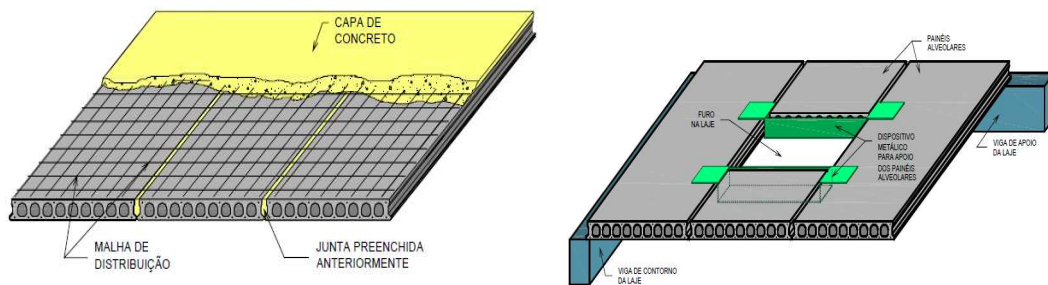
Laje alveolar com capa de concreto e sujeita a aberturas
